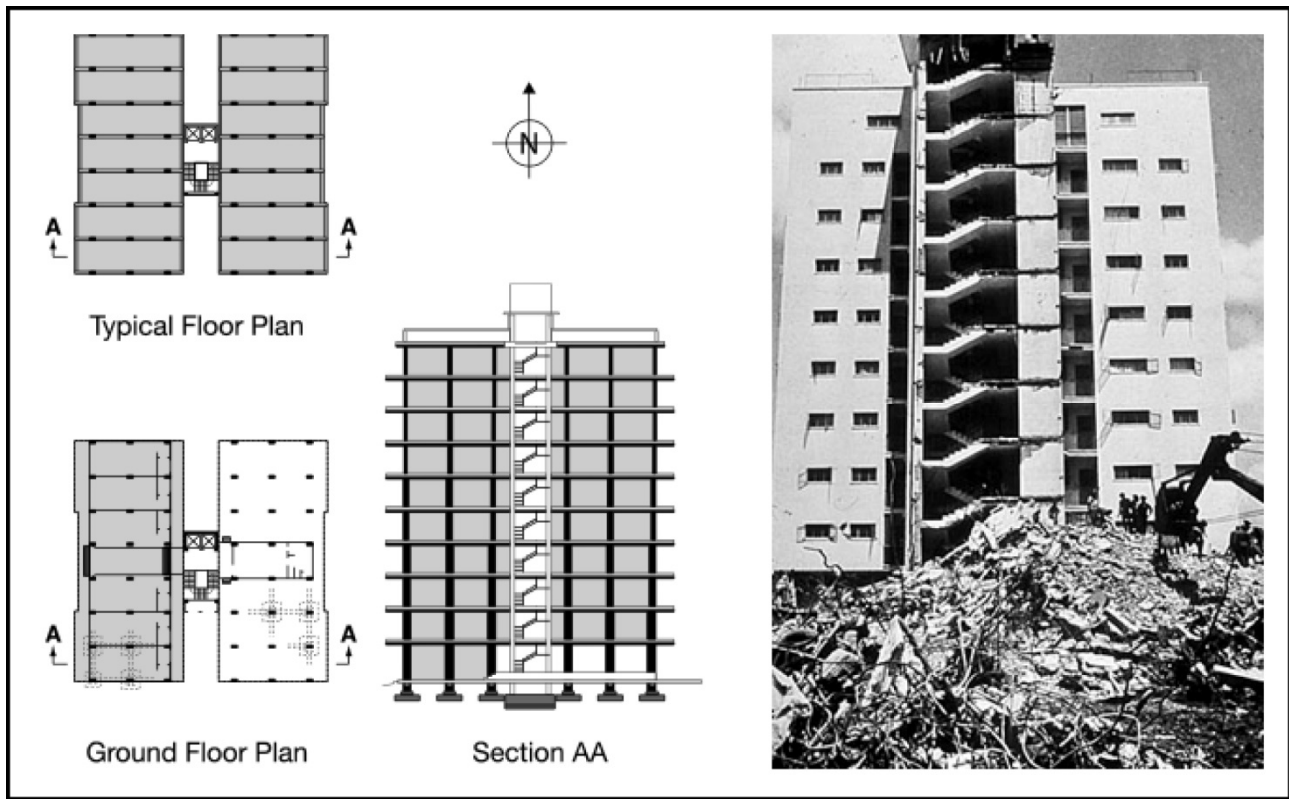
piante tipo, sezione e foto del Palazzo Corvin dove si possono vedere le differenze di impostazione strutturale nelle due ali dell'edificio.
